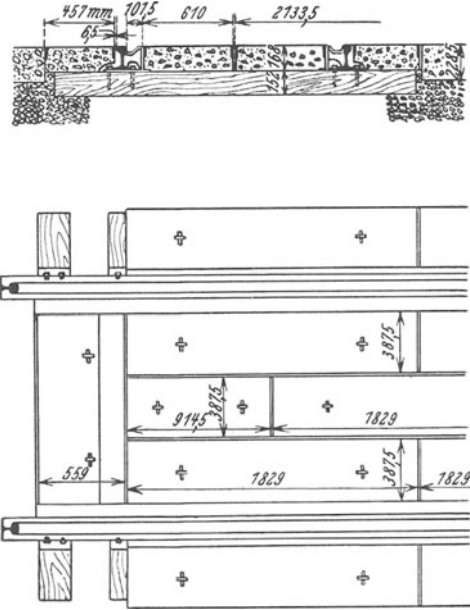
Eisenbahnübergänge mit Betonplatten ausgelegt.
